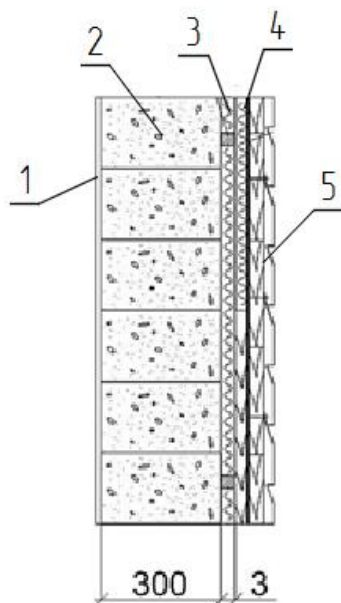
Ограждающая конструкция стены с вакуумным утеплителем: 1) известково-песчаная штукатурка; 2) блоки из ячеистого бетона D400, тип IV; 3) вакуумная панель; 4) пленка гидро-ветрозащитной для скатной кровли и фасадов ТехноНИКОЛЬ; 5) виниловый сайдинг Sauga.
